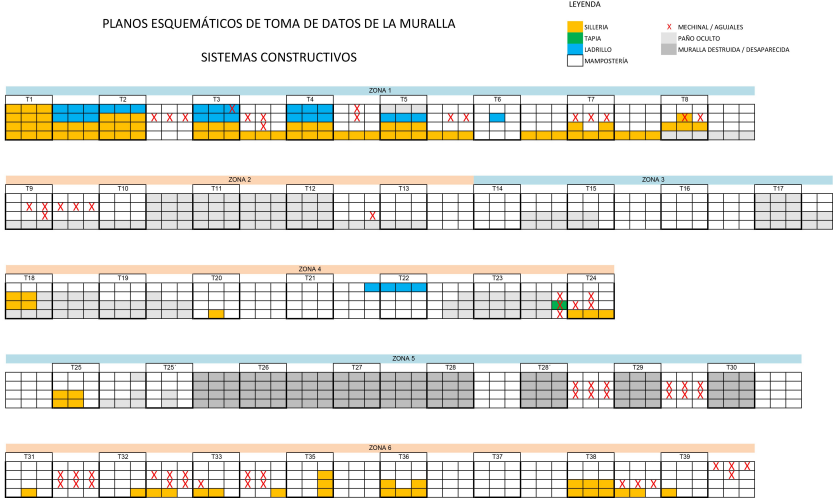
Mapa esquemático de la muralla en alzado en que se señalan los distintos sistemas constructivos que encontramos, desde la torre T1 hasta la T39 (fuente: autor)
